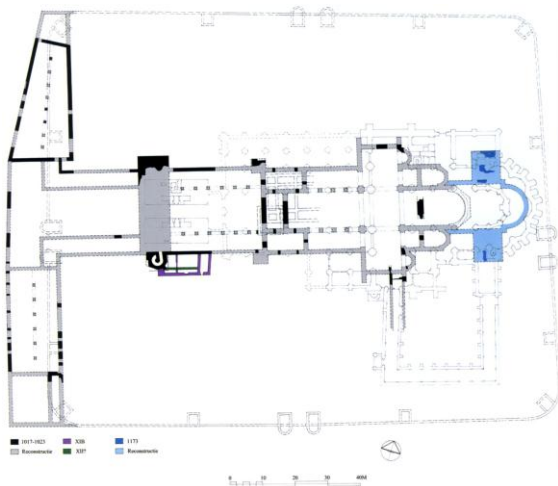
Grundriss (Rekonstruktion) des romanischen Kirchenbaus unter Bischof Adelbold II.
